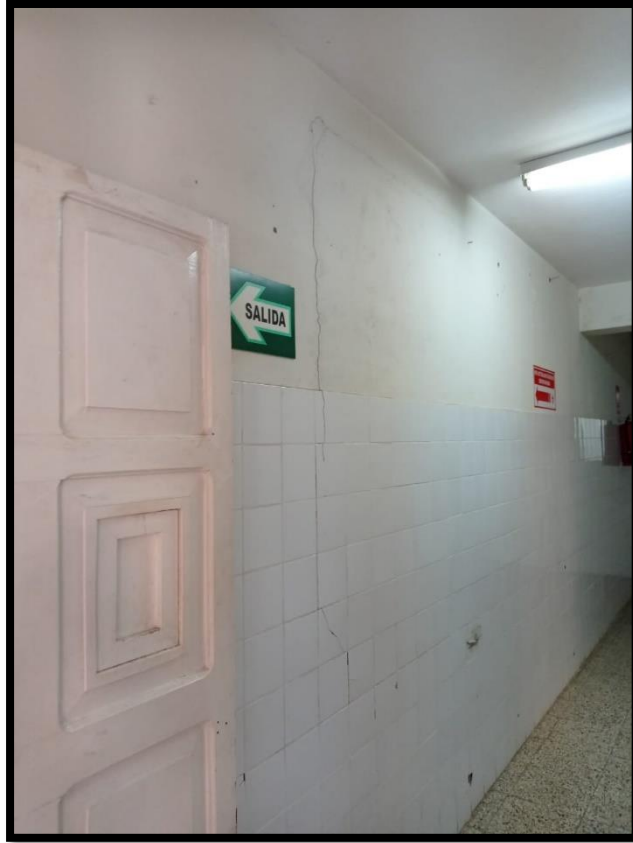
Fisuración en muro por dilatación de losa de techo.
